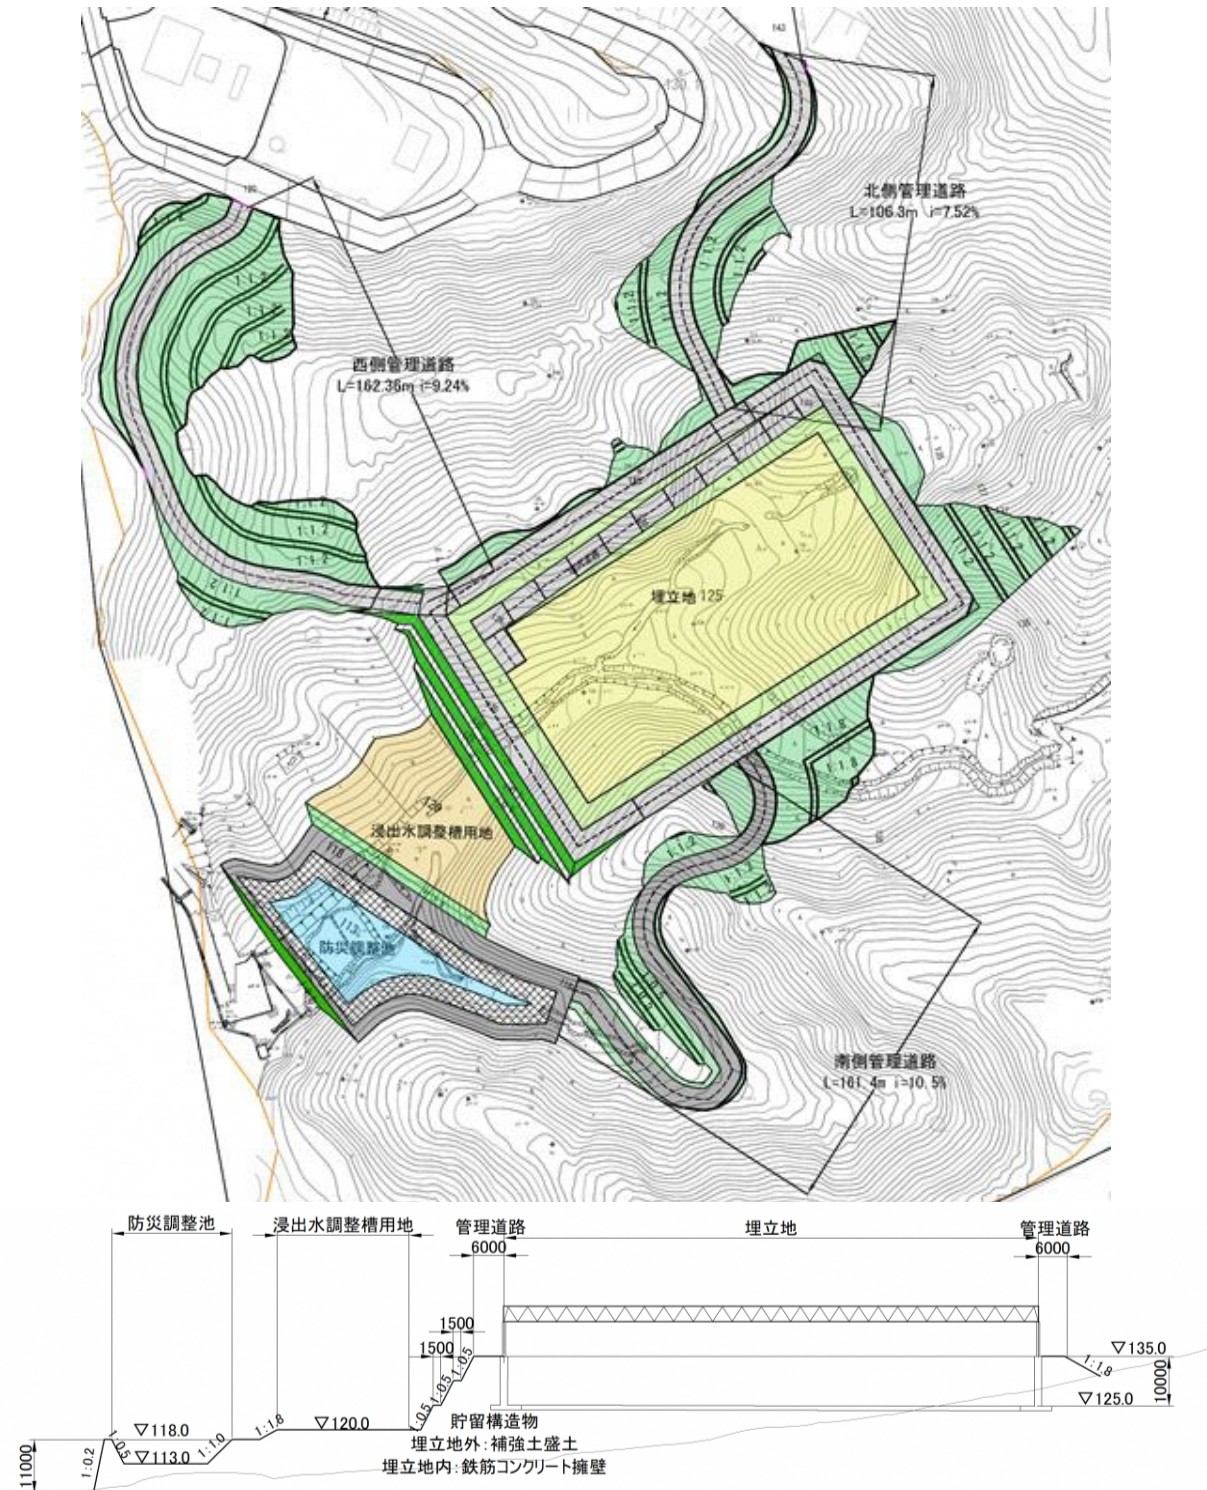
基本計画(案4及び案4') 平面図(上)、標準断面図(下)
